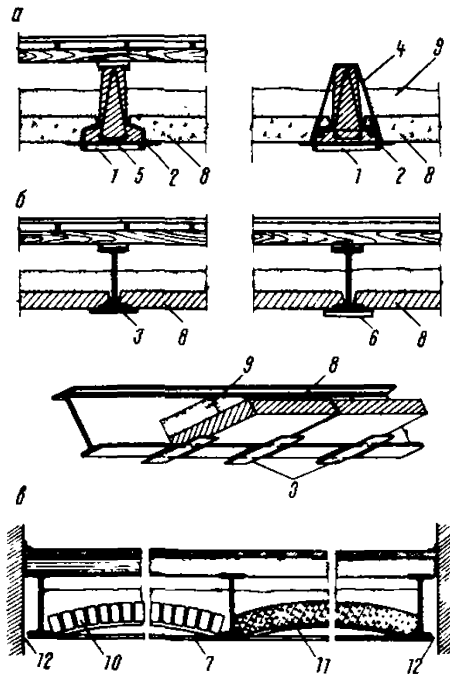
Схема увеличения опор сборных элементов перекрытий
